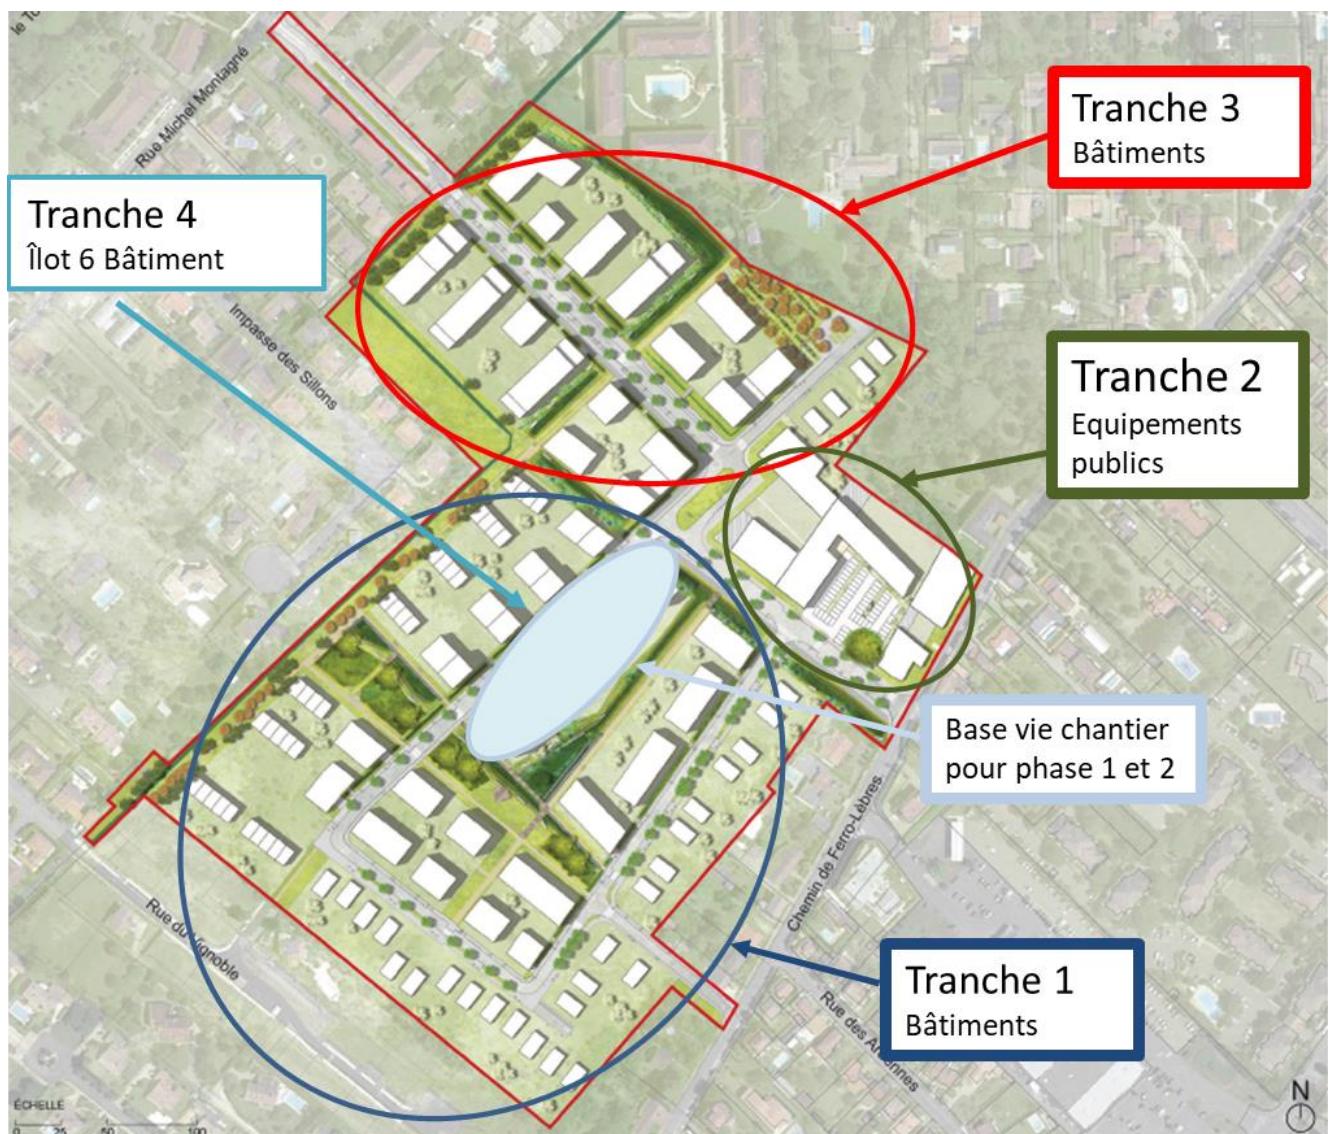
Temporalité des travaux, de terrassement et construction notamment
